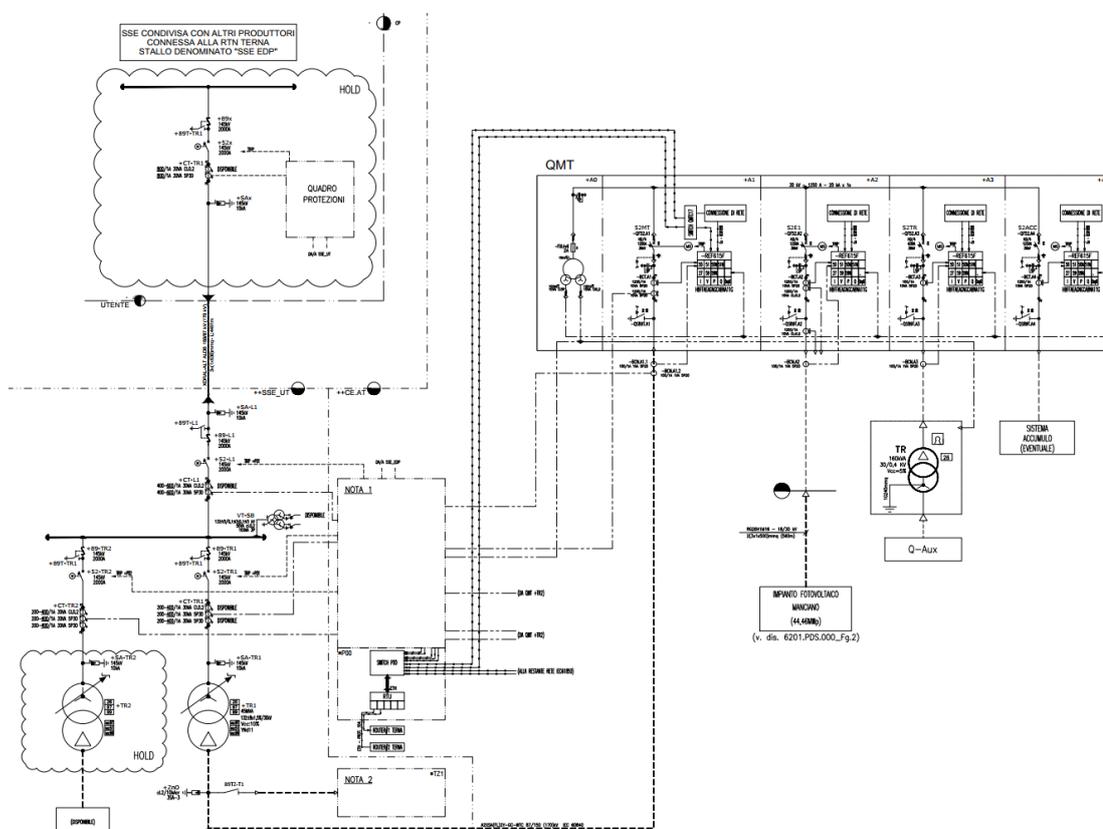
e Particolare 3 dello schema elettrico unifilare
